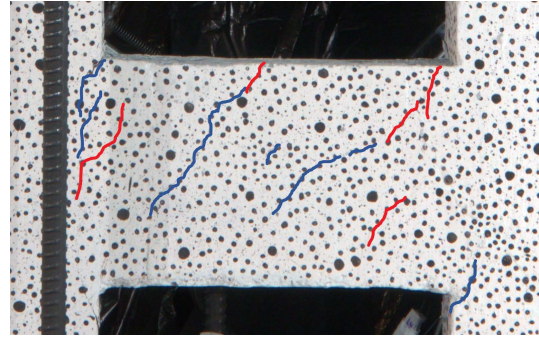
Grietas Vigas a -0.6 % Drift
